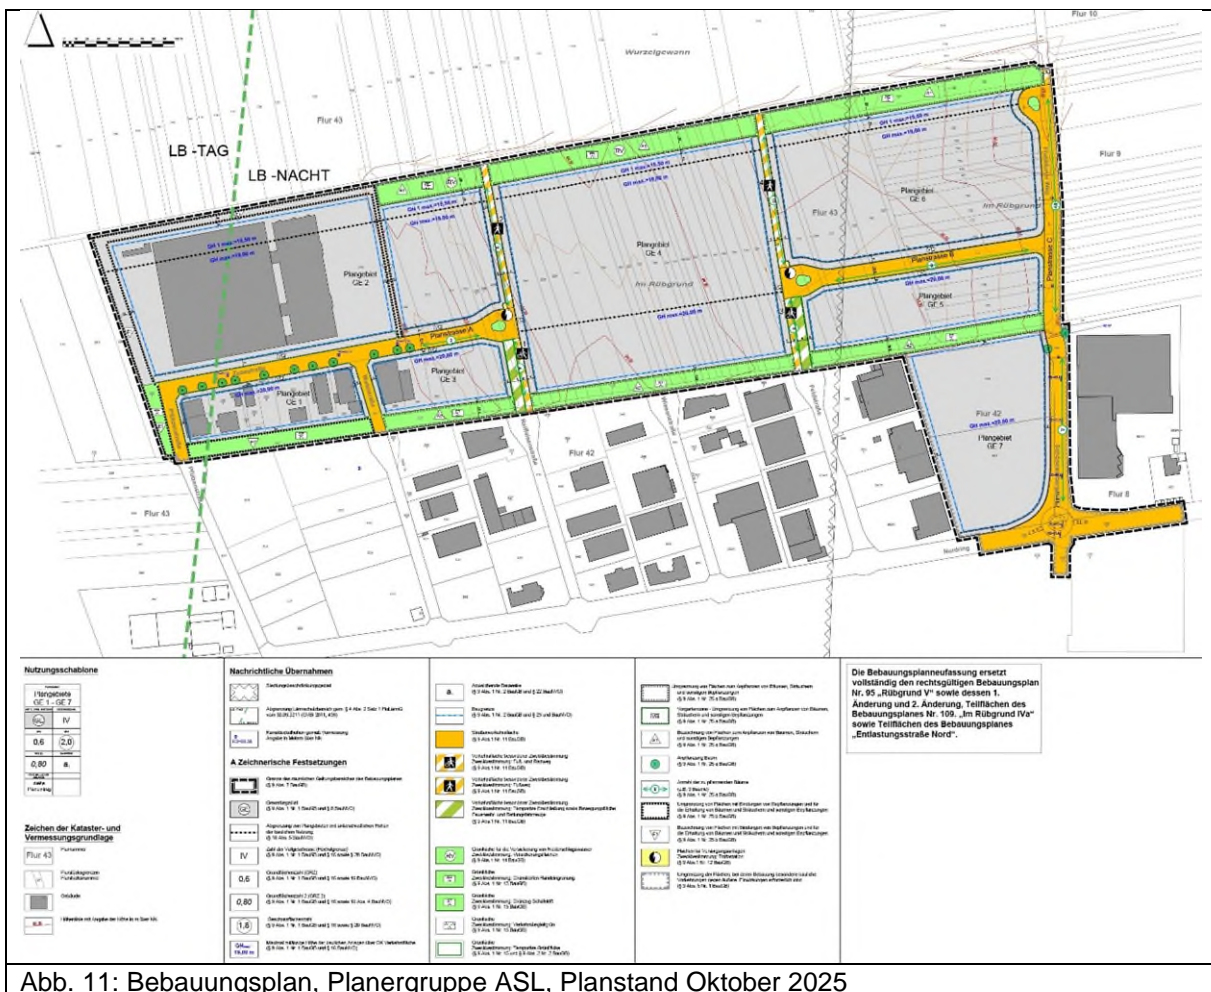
Bebauungsplan, Planergruppe ASL, Planstand Oktober 2025
